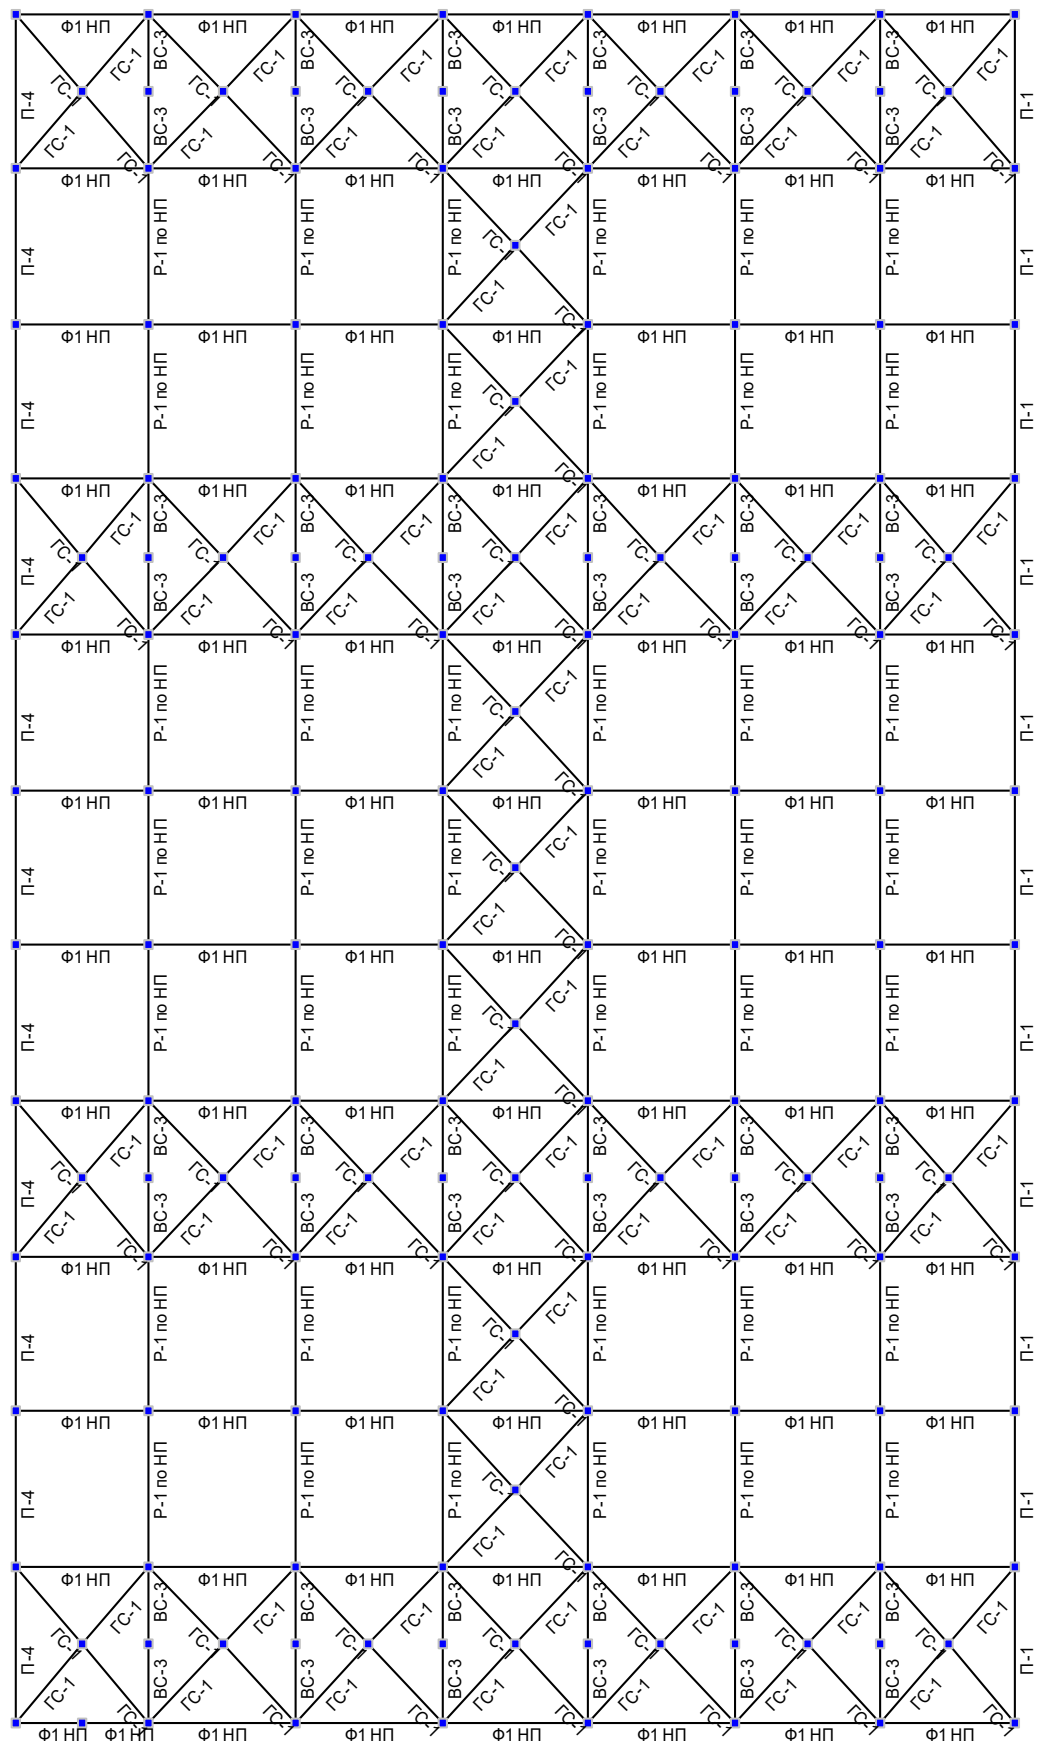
Схема распорок и горизонтальных связей по нижнему поясу арочной фермы
